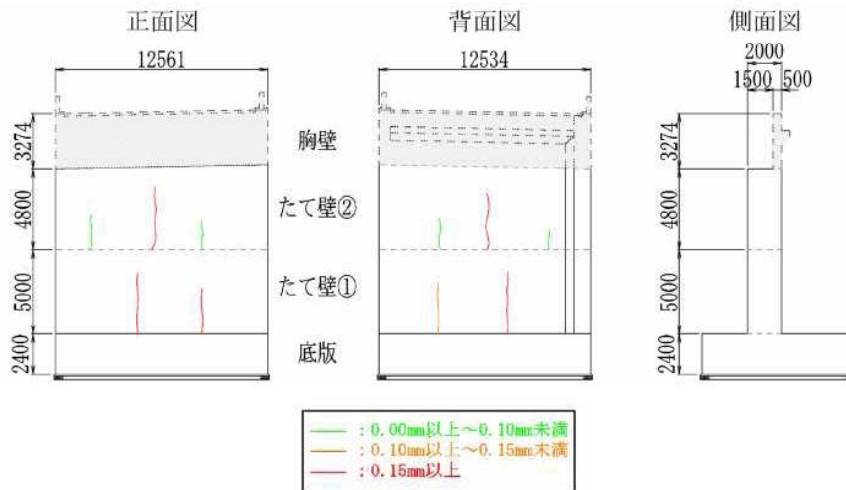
橋台たて壁のひび割れ状況(高炉B+膨張材)
